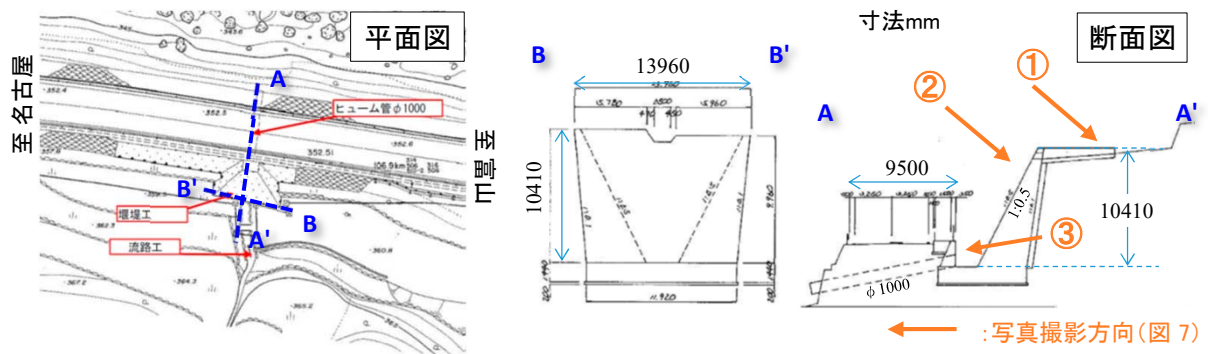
道路被害箇所周辺の被害発生当時の施設平面図及び断面図
